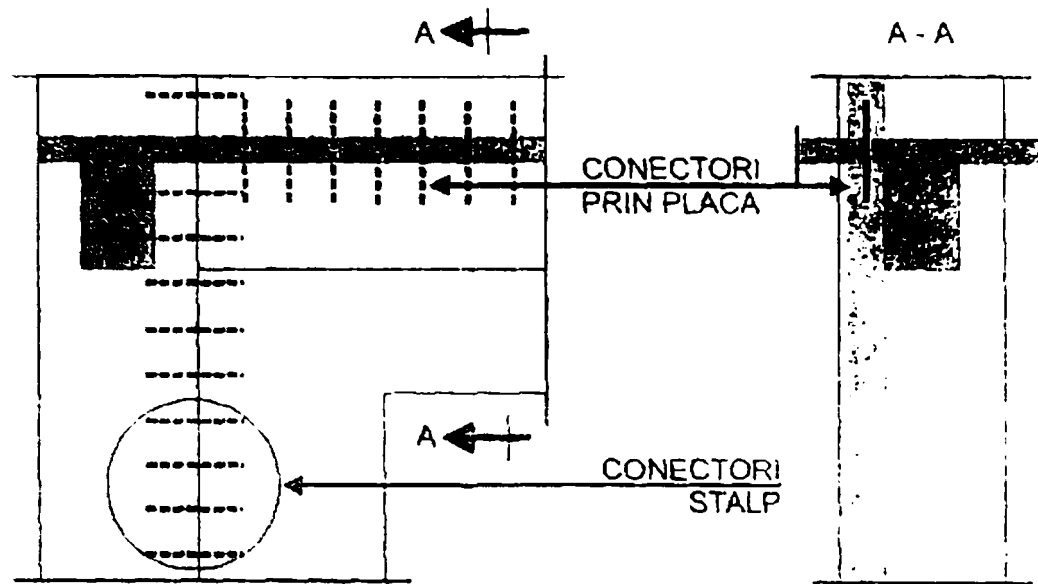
5. Procedu de conectare a panourilor din beton armat introduse lateral grinzii
